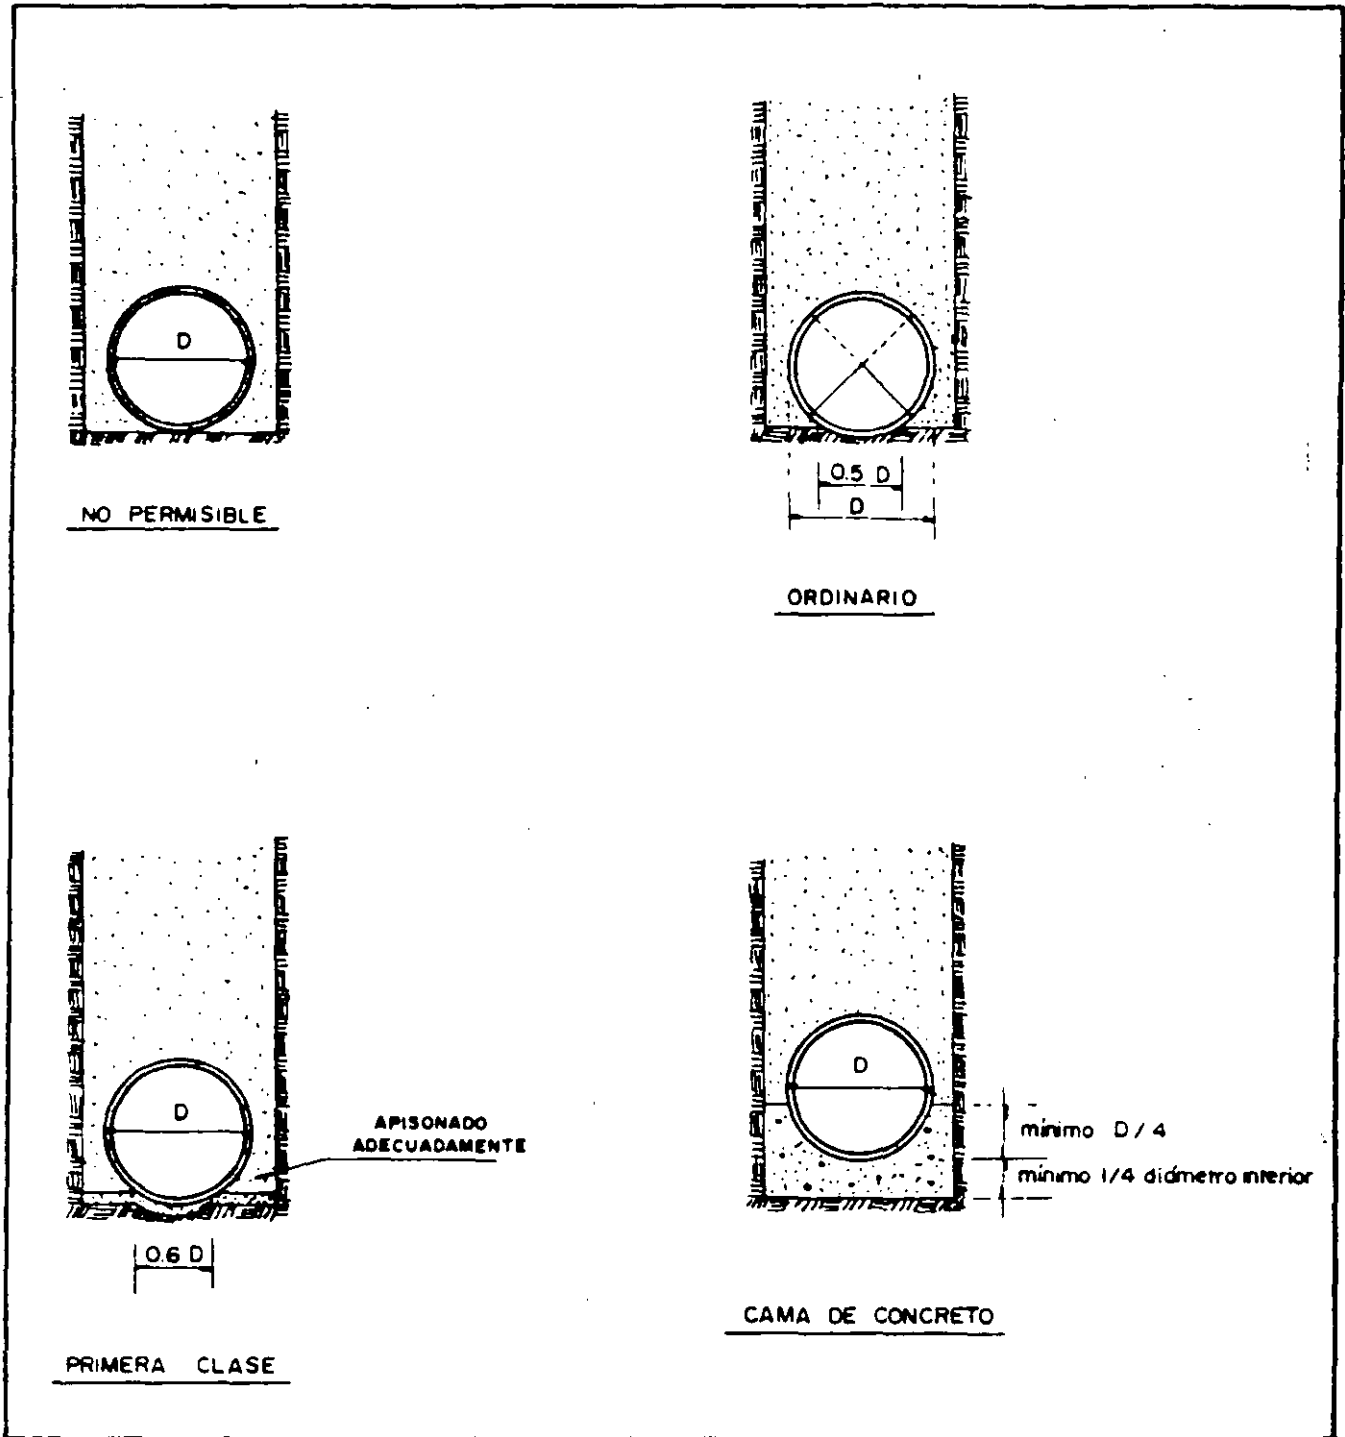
Tipos de camas para tuberías en zanjas
